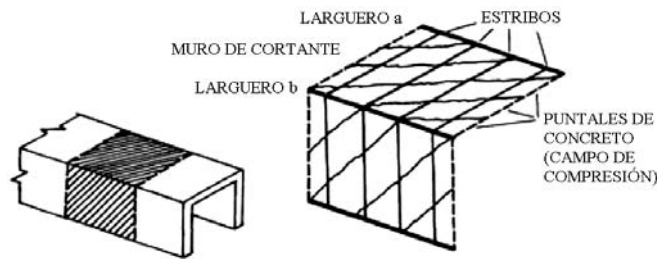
Pared de cortante en una trabe de concreto reforzado (Grob y Thürlimann 1976). Modificada
